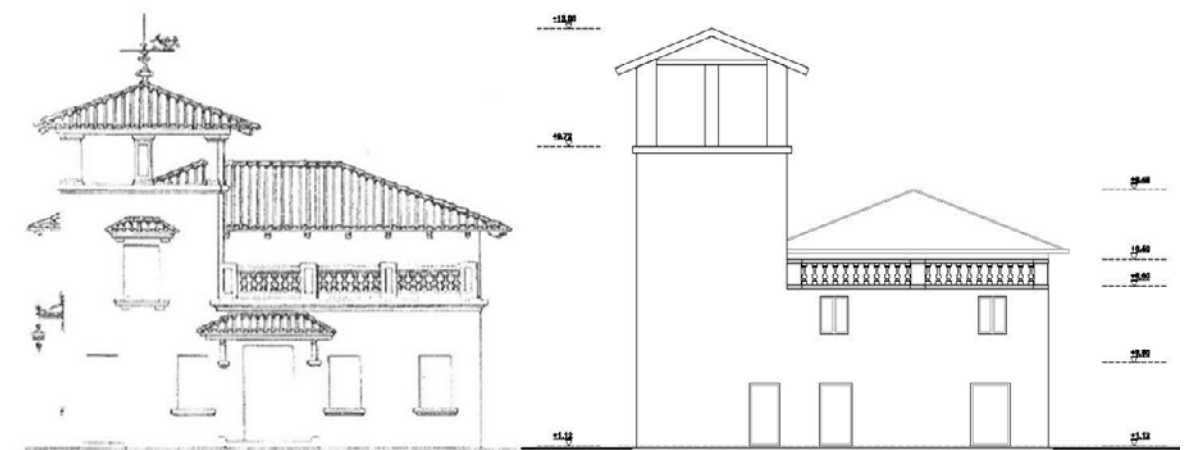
Fachada Oeste. Comparativa del proyecto original con el estado actual.
